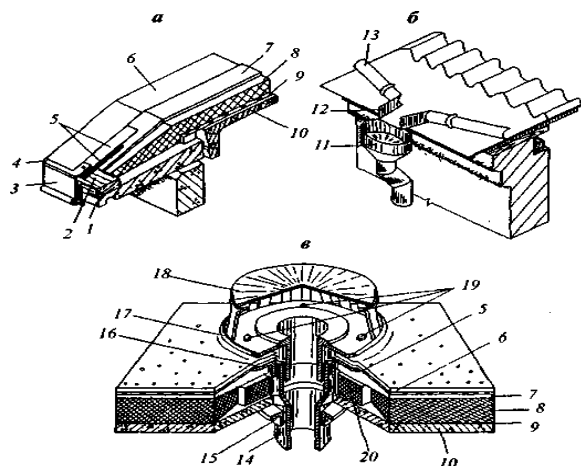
Водоотвод с покрытий промышленных зданий:
